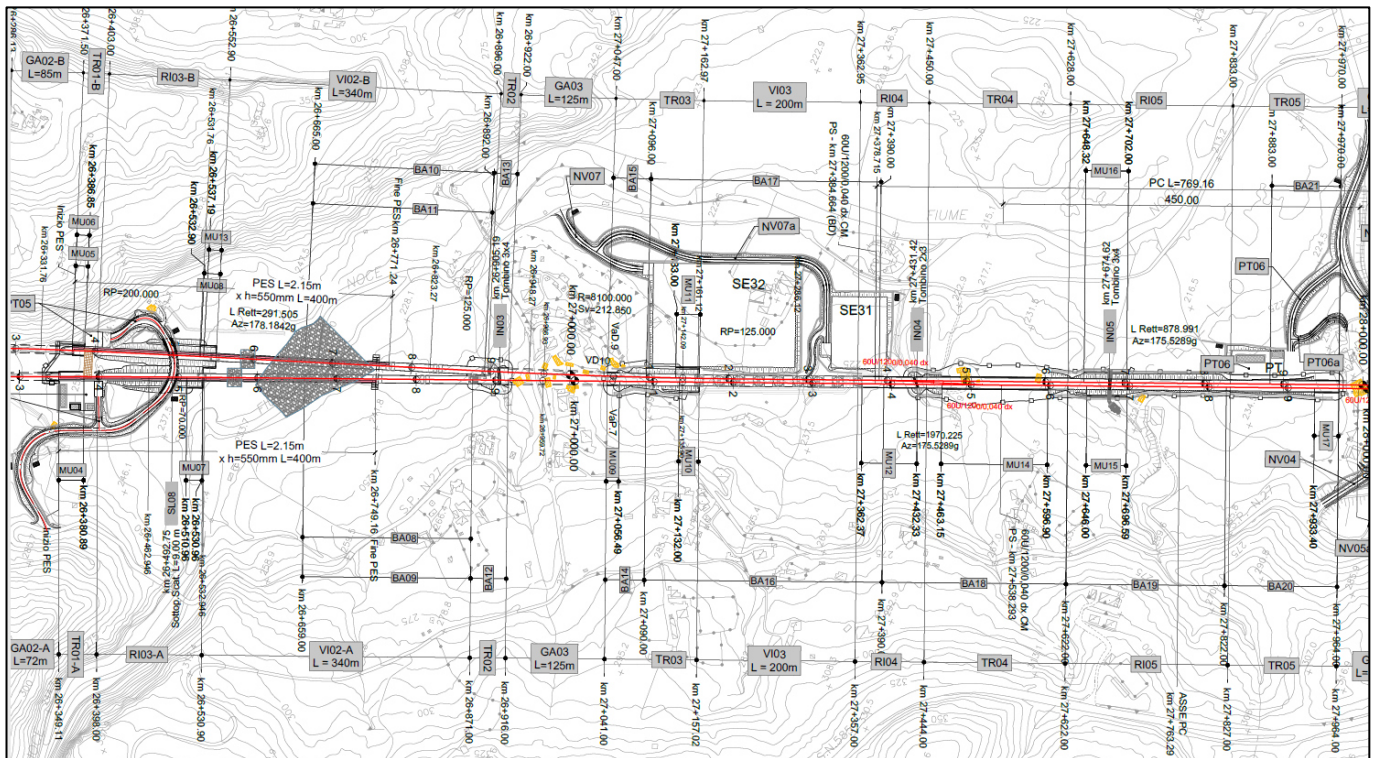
Planimetria di progetto da km 26+349 al km 27+964 BP
